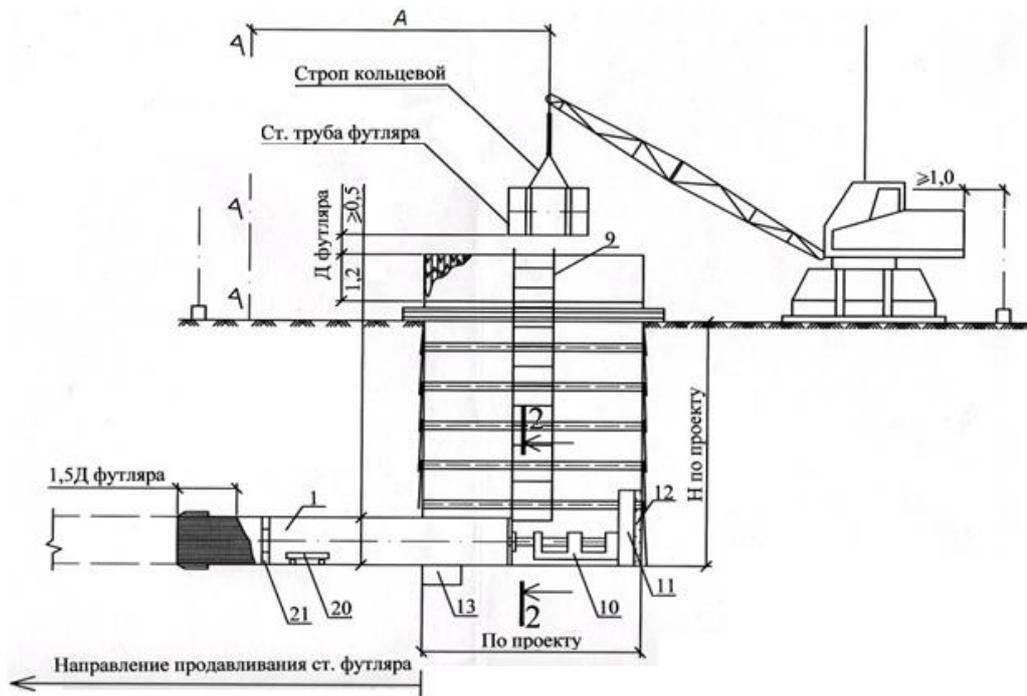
Схема продавливания железобетонных труб домкратной установкой. (сечение 1-1, М 1:100)
